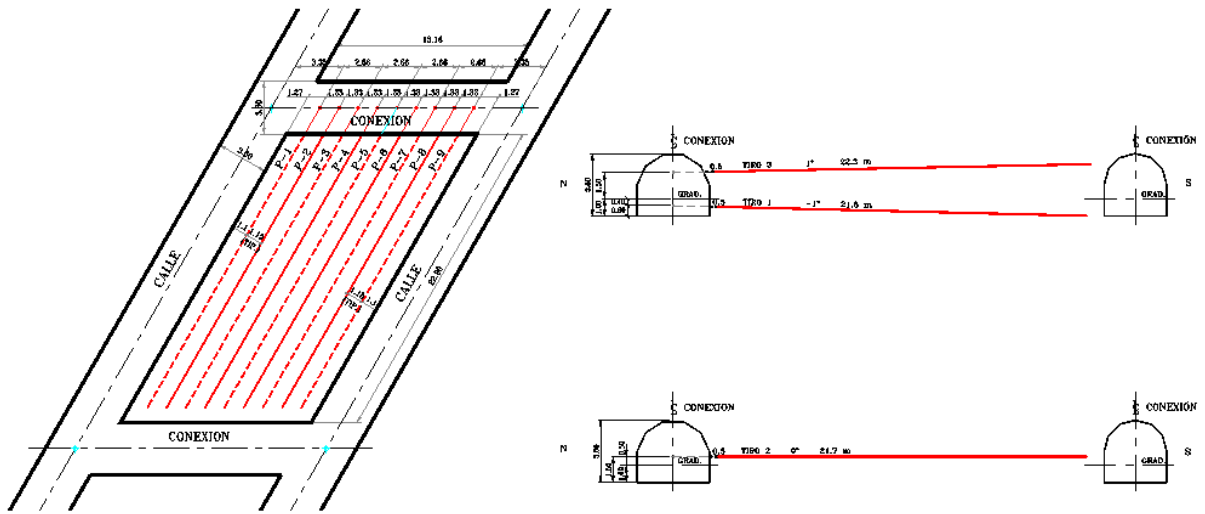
Corte plano mediante conexiones y tiros paralelos en Reservas Norte (Undercutting Workshop, 2008)
